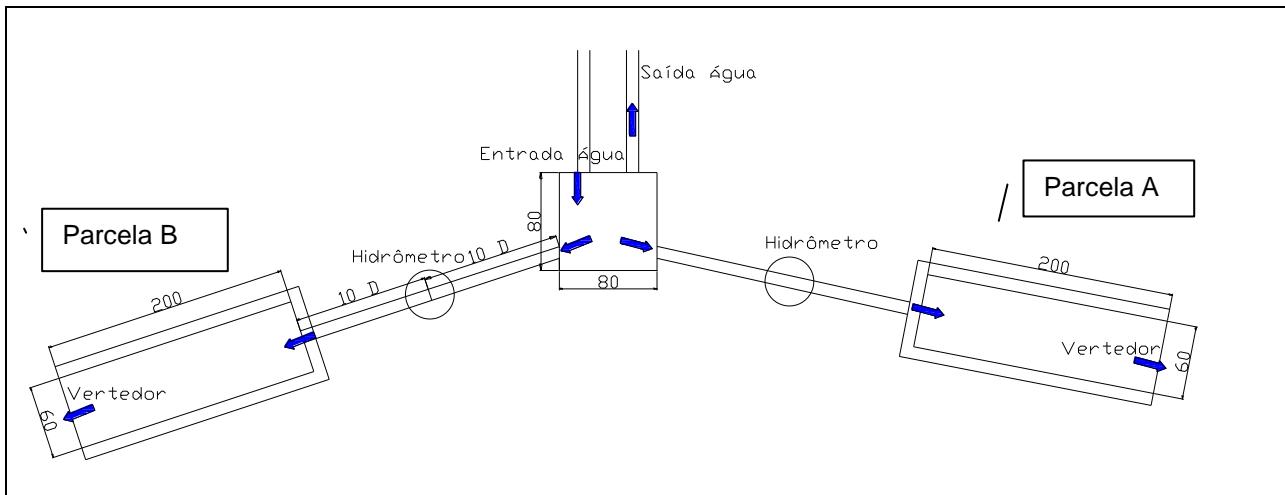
Planta Baixa do sistema “Vertedor x Hidrômetro”
